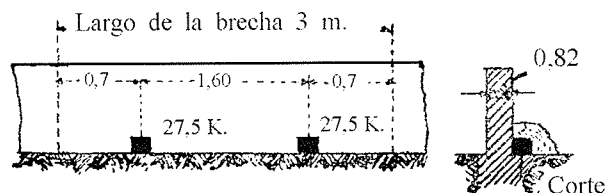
Cargas concentradas y adosadas al pie de un muro
